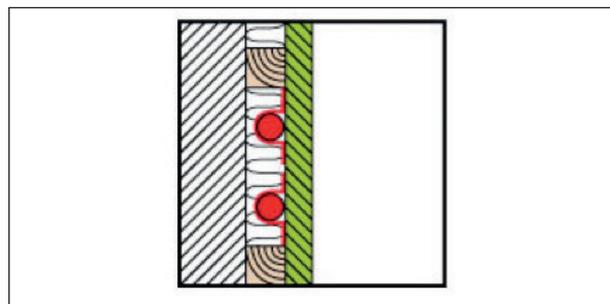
TW1 - Rohrsystem in Unterkonstruktion mit Trockenausbauplatte
